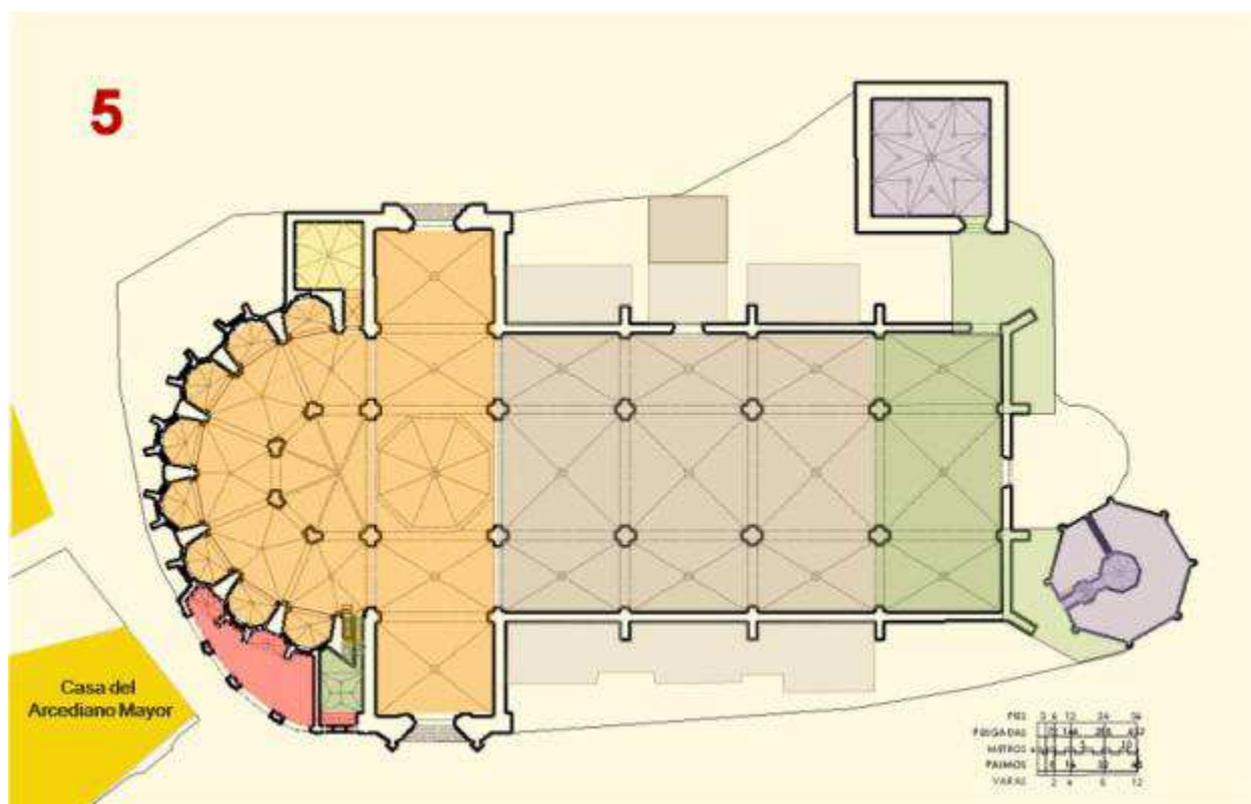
12.5 Evolución constructiva. Fase 5 / Planta <sup>323</sup>
